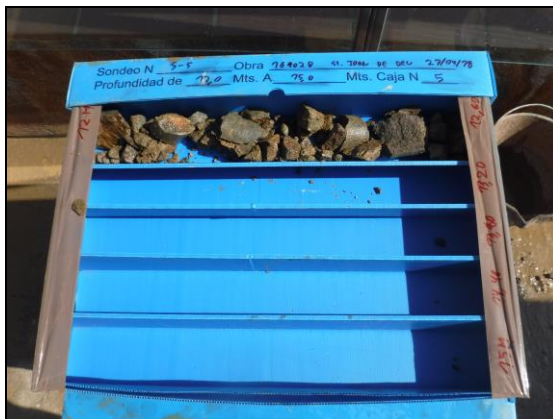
Sondeig S-5, caixa de 12 a 15 metres.
